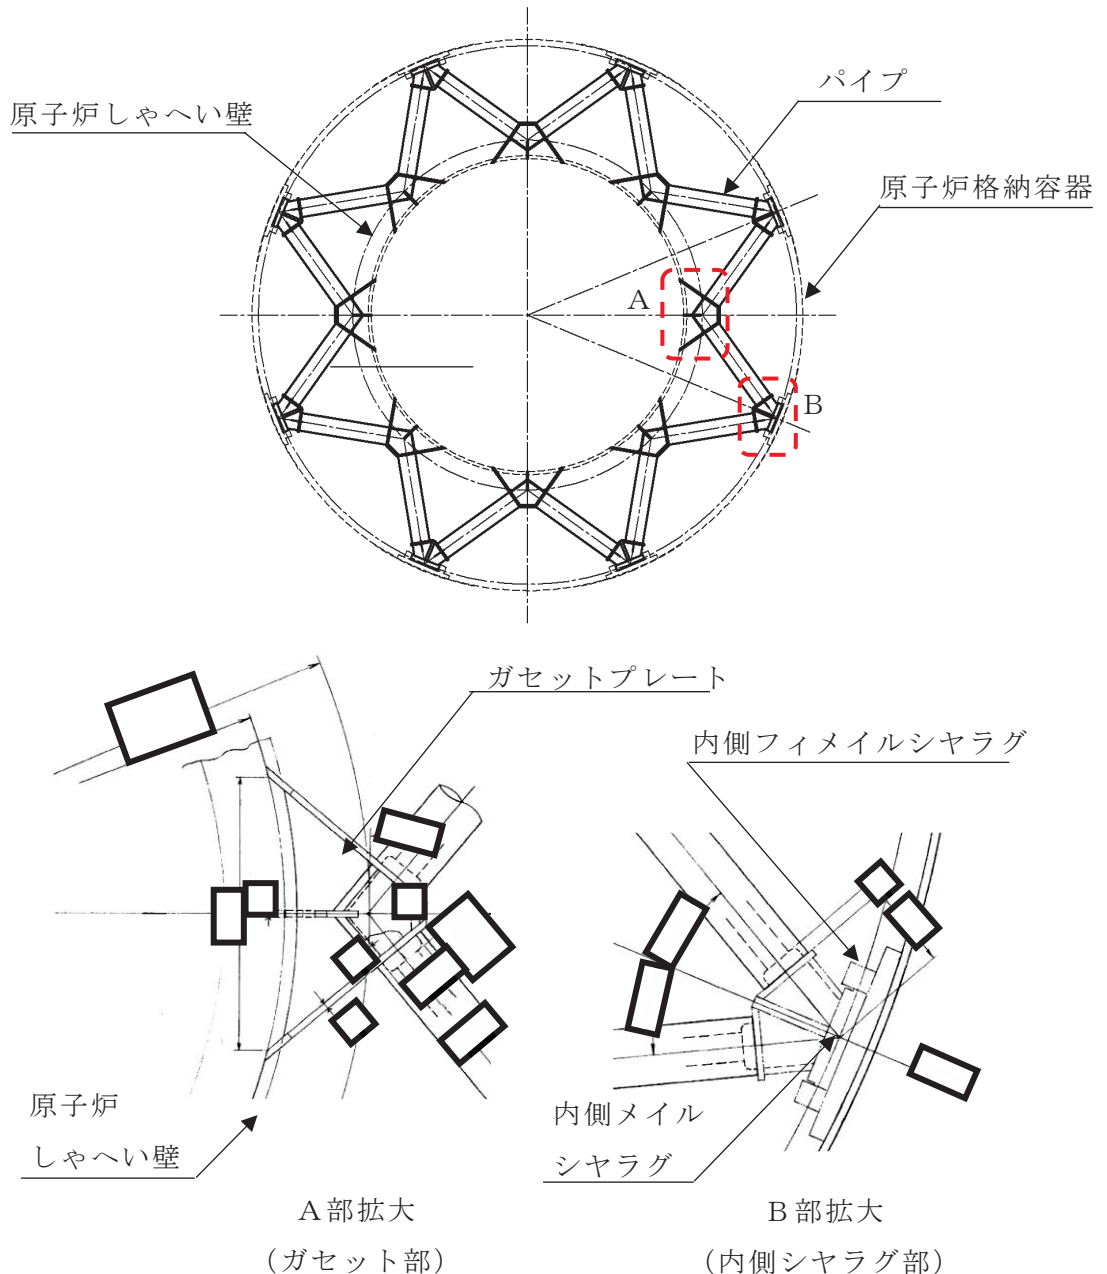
原子炉格納容器スタビライザの構造概要 (平面図)
